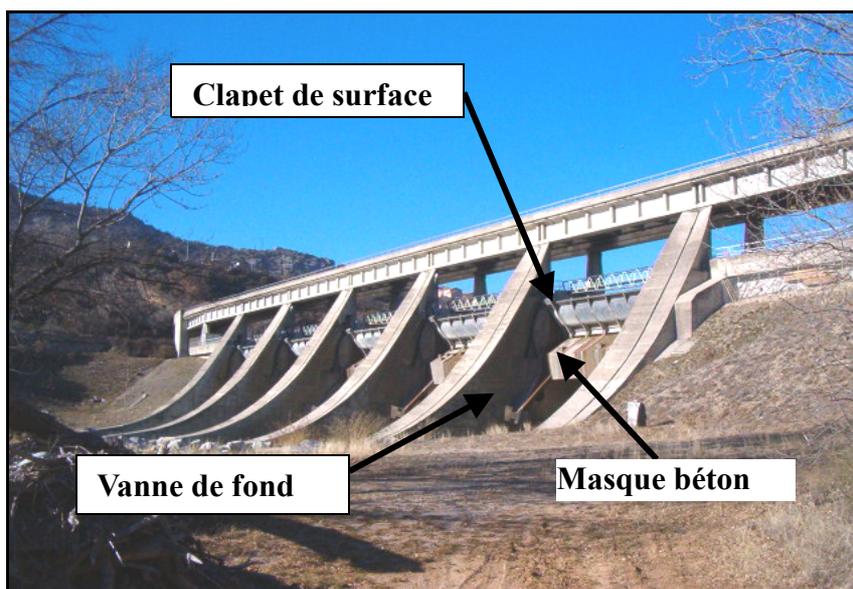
Barrage de L'Escale – ouvrages d'évacuation.
